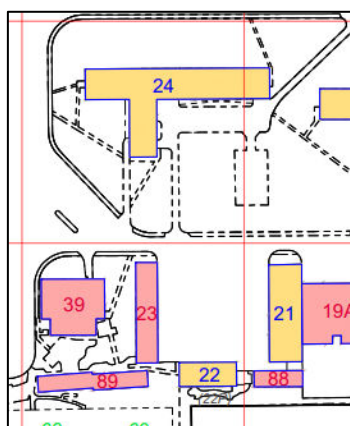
Lage Baufeld verbleibende Gebäude 21, 22, 24
